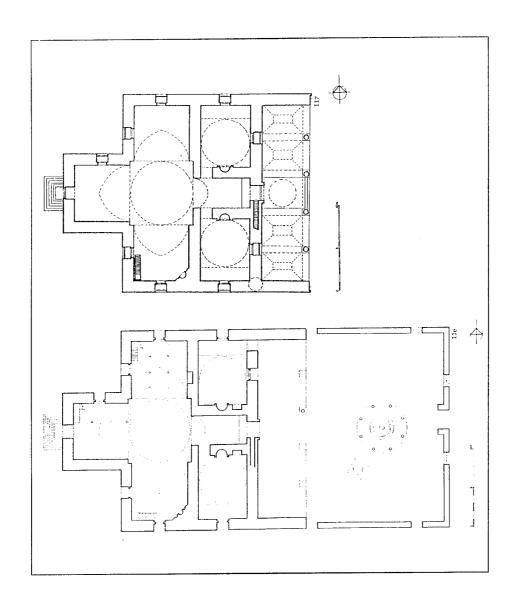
مسقط أفقي لمسجد محمود باشا في إستانبول (عن : ايفردى) .
